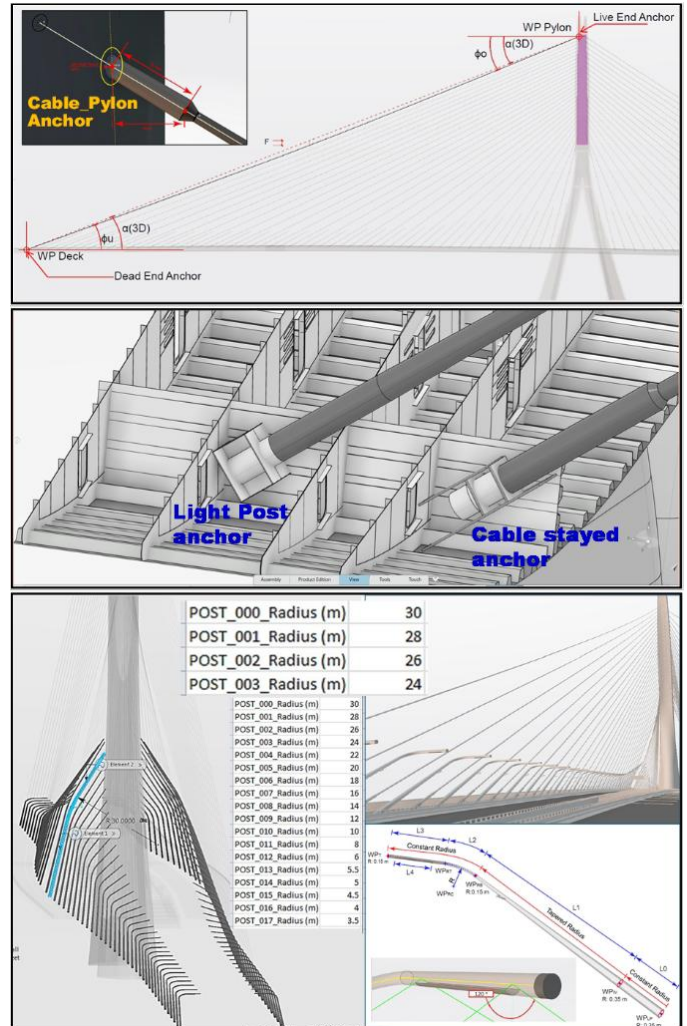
8: Vigas de acero del puente principal (tablero)
